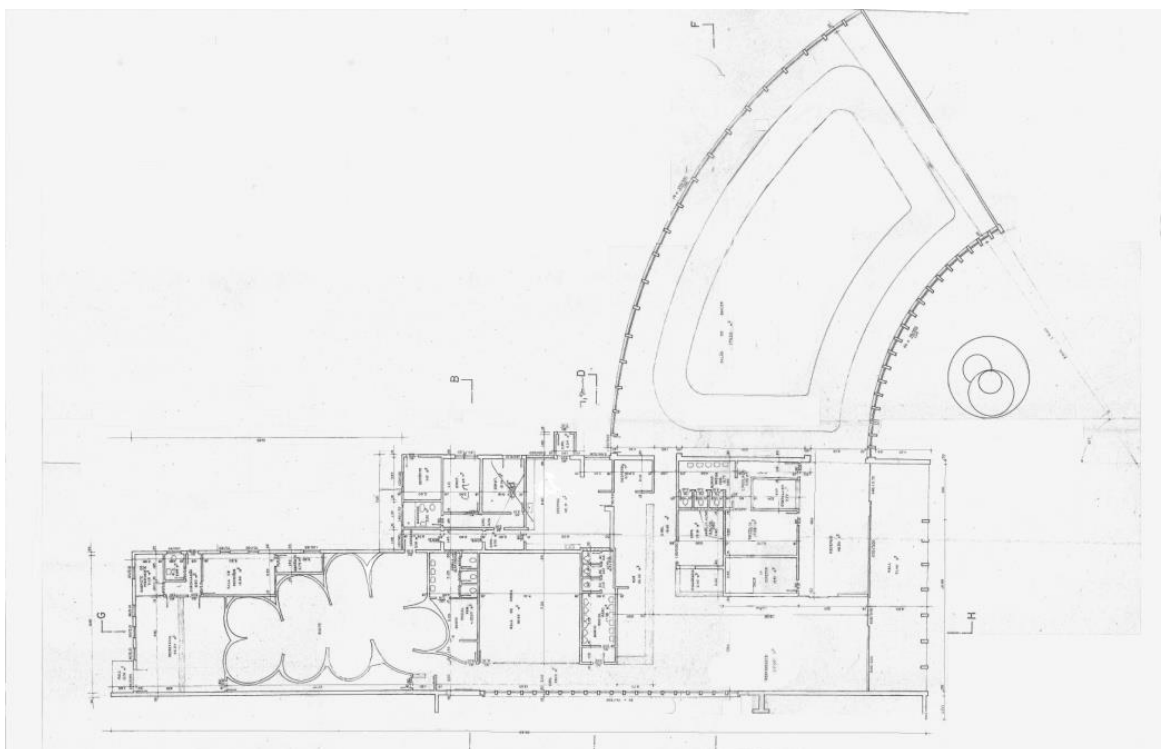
Planta Baixa da SAT. Projeto de Nestor Hilgert, inaugurado em 1957.
